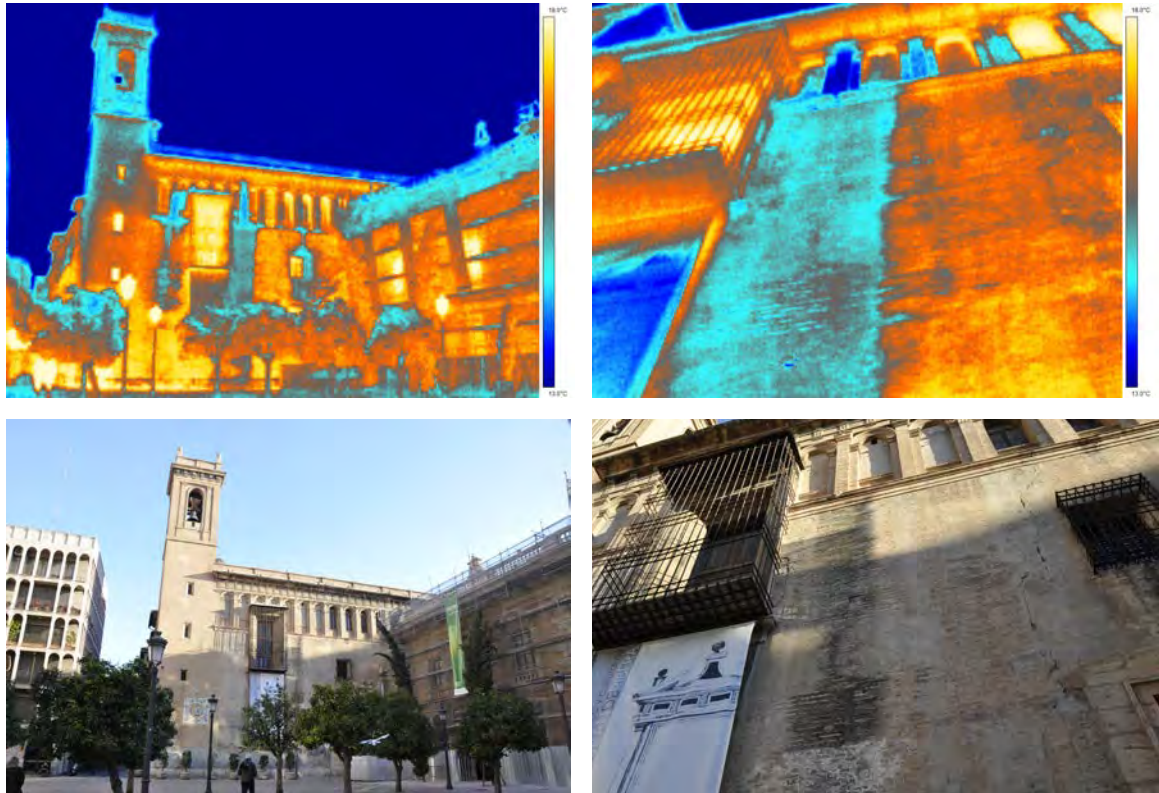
Vista general y detalle de la fachada principal (sur).
